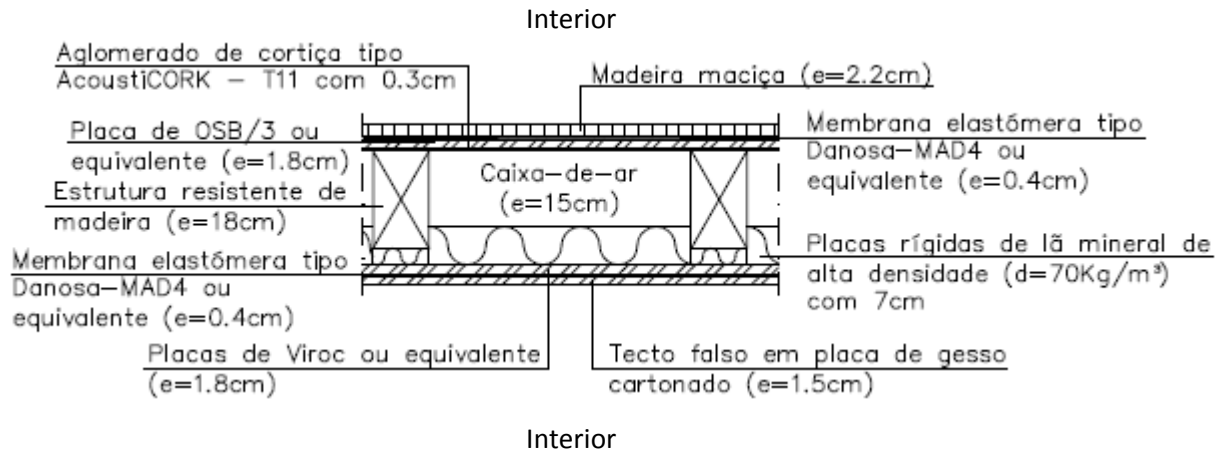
Pormenor construtivo do pavimento 1 [19]
